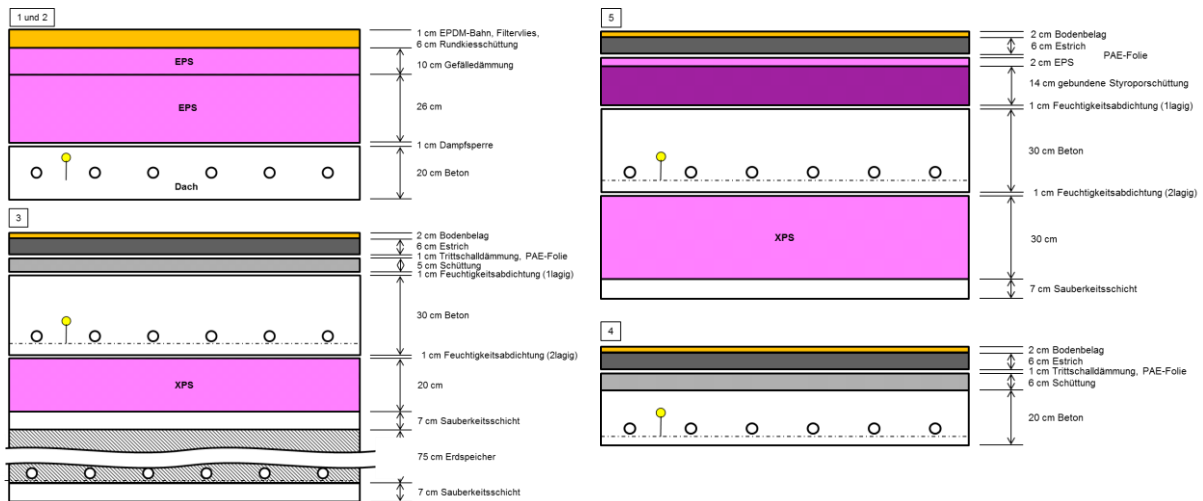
Aufbau des Erdspeichers und der bauteilaktivierten Platten (Quelle: Einreichplan, eigene Darstellung)
